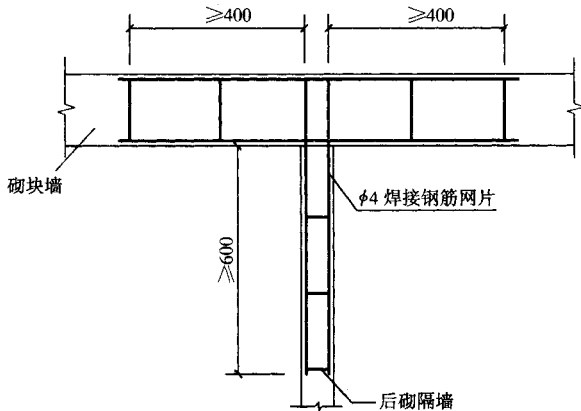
砌块墙与后砌隔墙交接处钢筋网片
